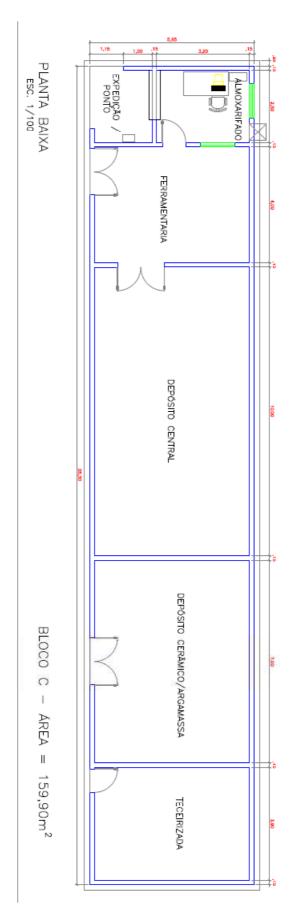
Planta baixa do terceiro bloco do barração de 50 pessoas.
